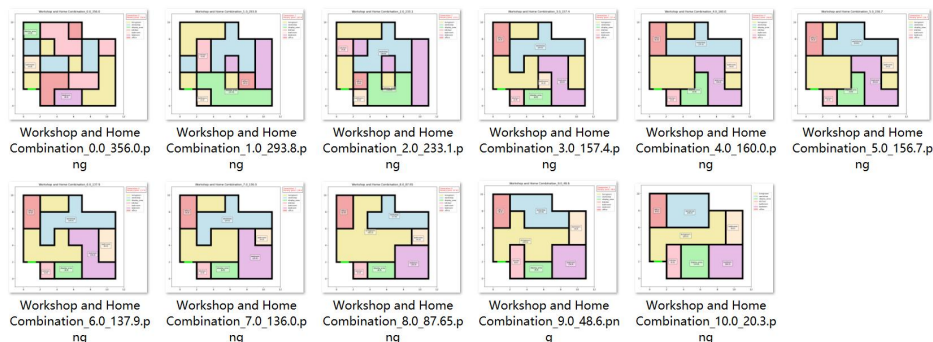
Chat2Plan 生成平面图结果（清华大学建筑学院提供）
